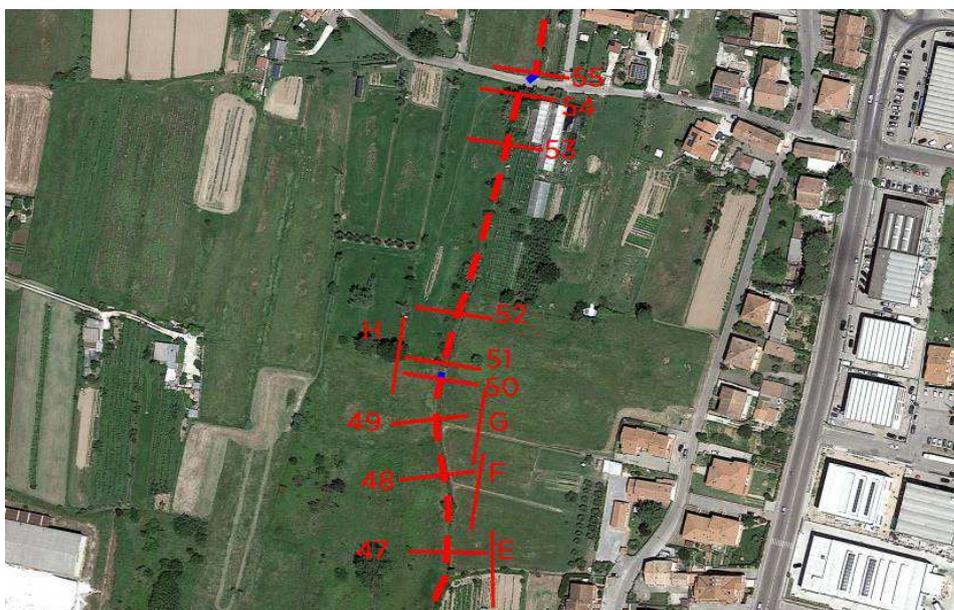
Andamento planimetrico Fosso Arrù come da rilievo topografico
